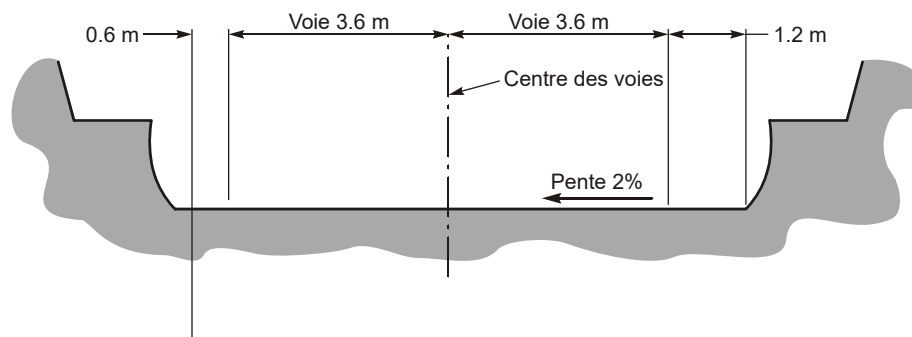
Section typique d'un tunnel routier à deux voies (FHWA, 2009)
